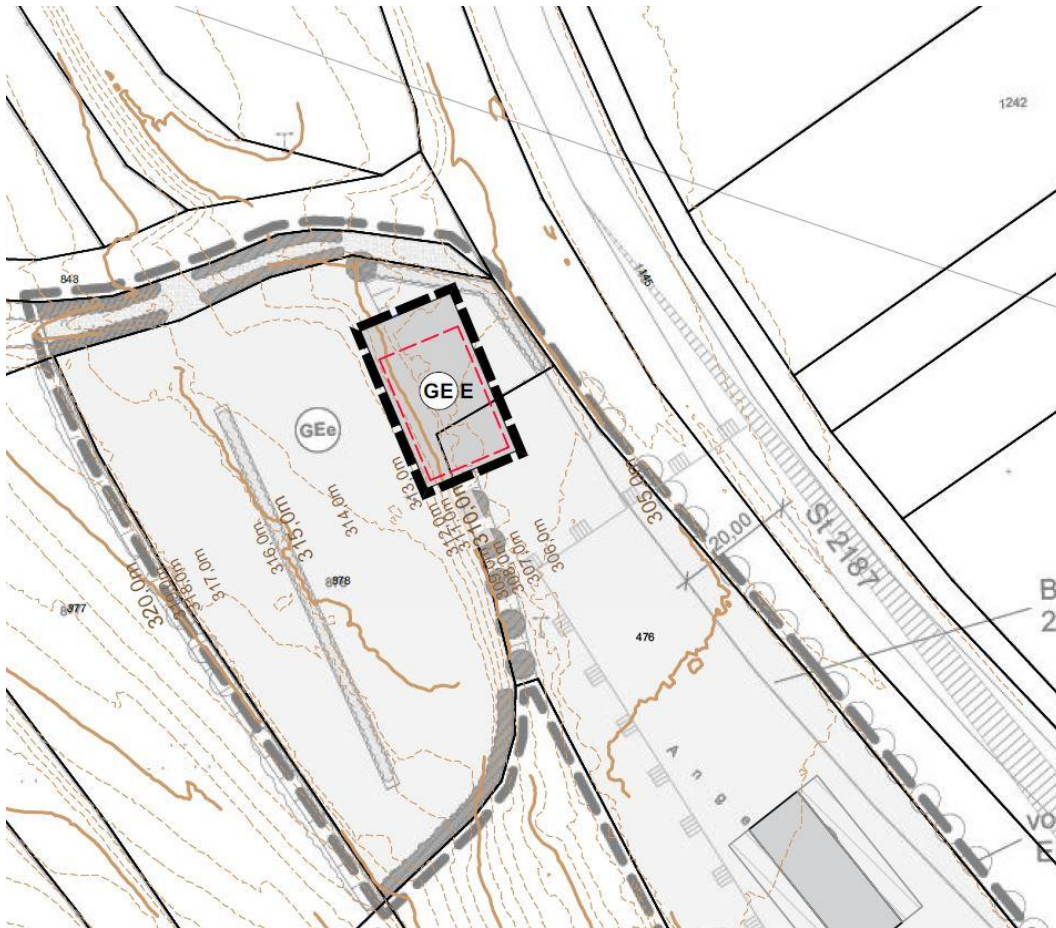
Ausschnitt, 1. Änderung des Bebauungsplans „Anger-Gasseldorf“ Stand: 13.03.2024
